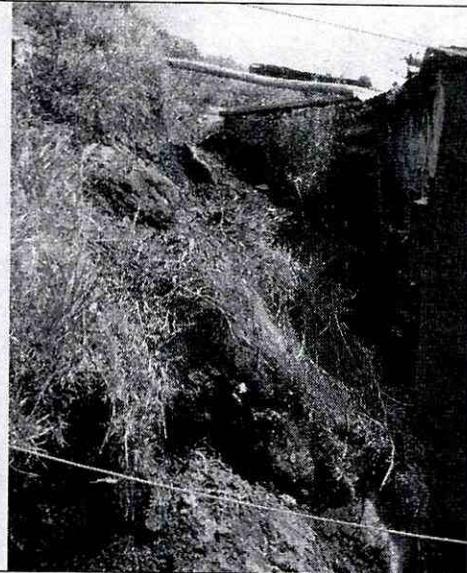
Talud de corte costado occidental de la vivienda de la Calle 80 Sur No. 18H-73, afectado por proceso de remoción.
